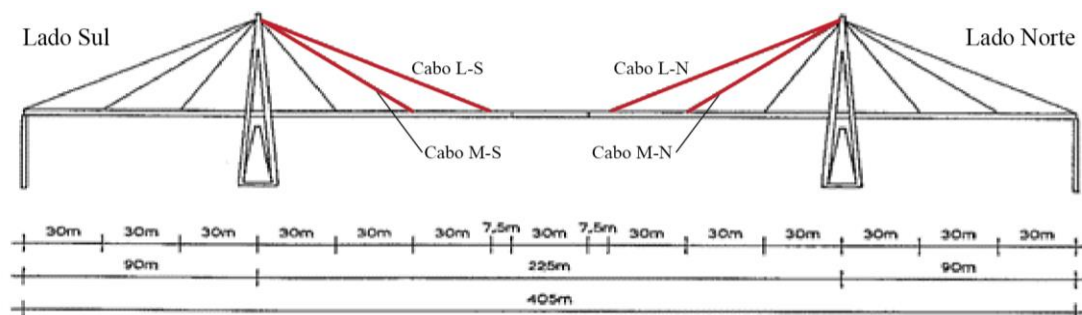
Plano de monitorização (alçado longitudinal visto de montante para jusante).
